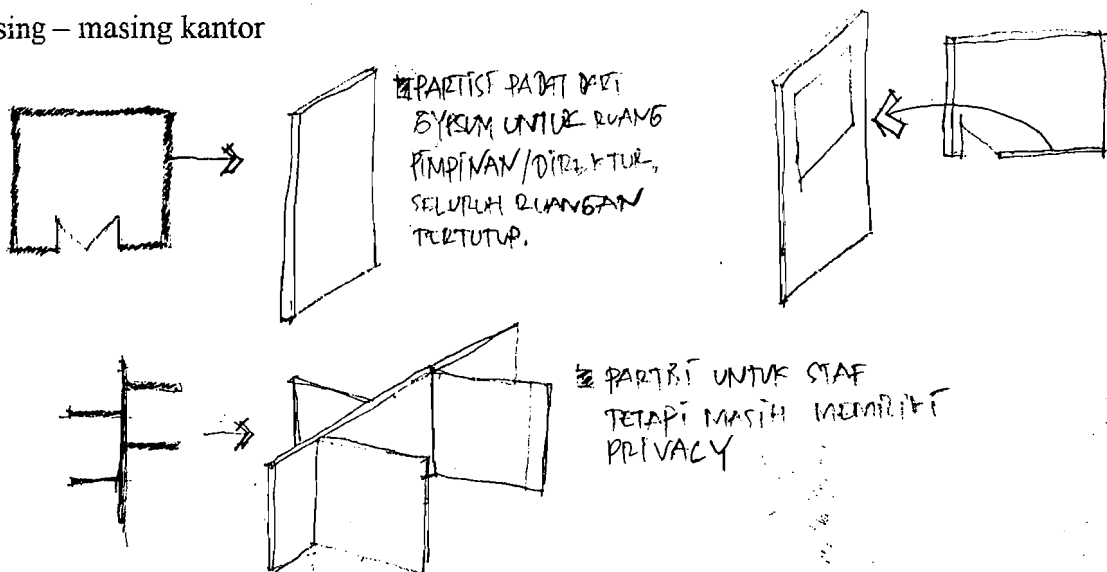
Hierarki Ruang Privacy Secara Vertikal
